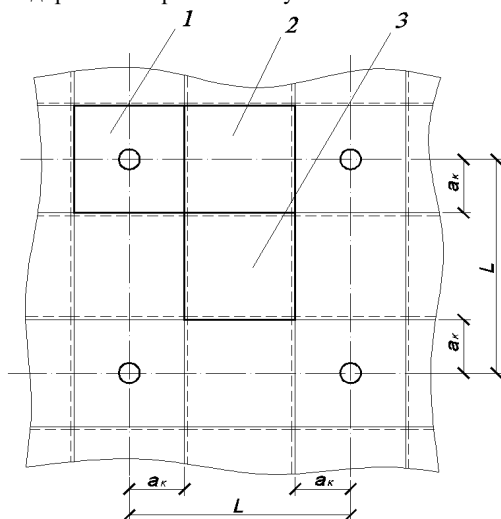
Фрагмент збірного сталезалізобетонного безбалкового перекриття:
